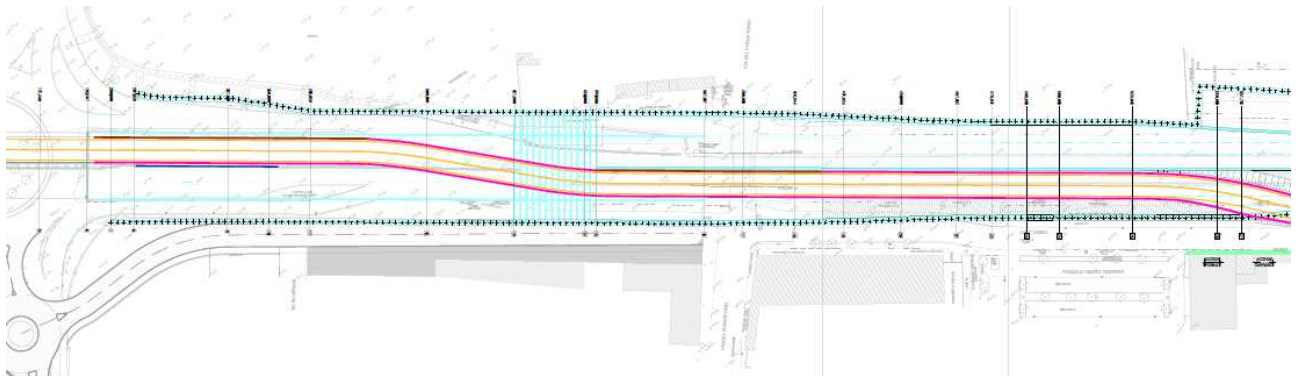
Planimetria deviazione provvisoria Fase 3 (parte 1)
